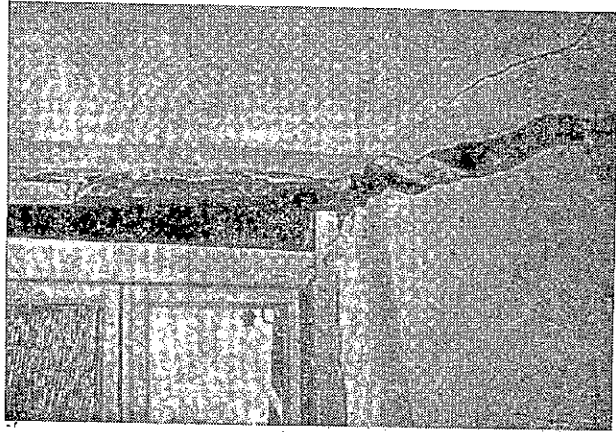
Поврежденные здания из бутобулыжной кладки при землетрясении 17 июня 1967 г.
